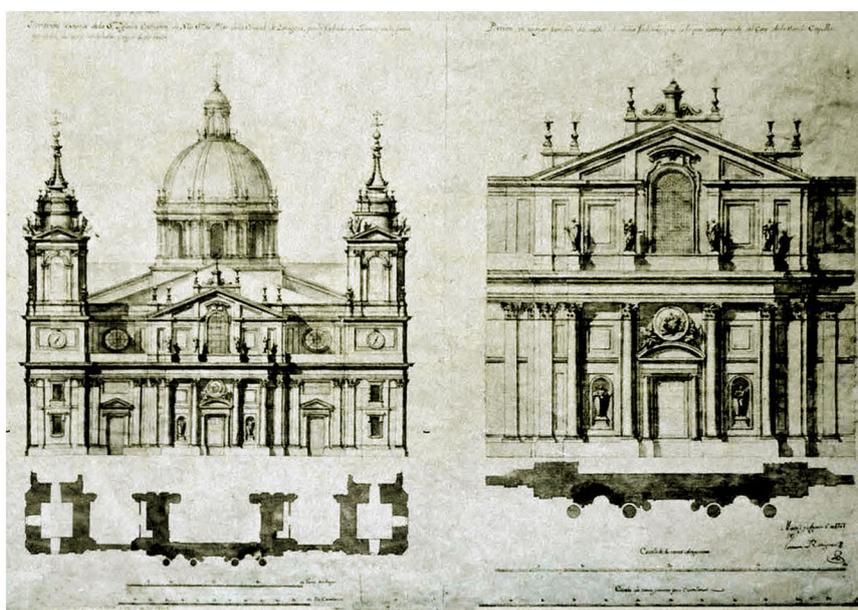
Ventura Rodríguez, propuesta para el alzado lateral del templo del Pilar de Zaragoza, 1761. Izquierda, alzado en conjunto; derecha, detalle del frontis que abre hacia la Santa Capilla.
